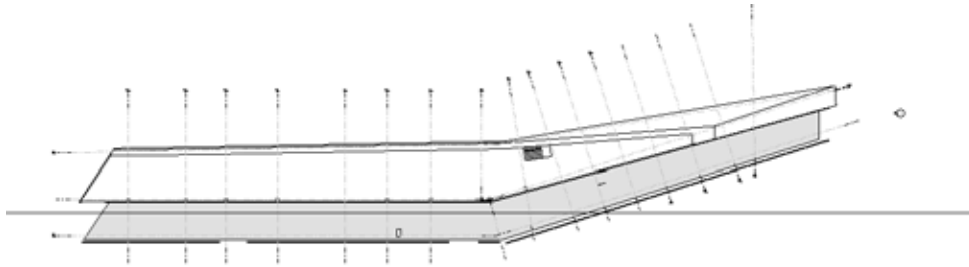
Sector A. planta estructura techo +17,50 mts. (2017)
